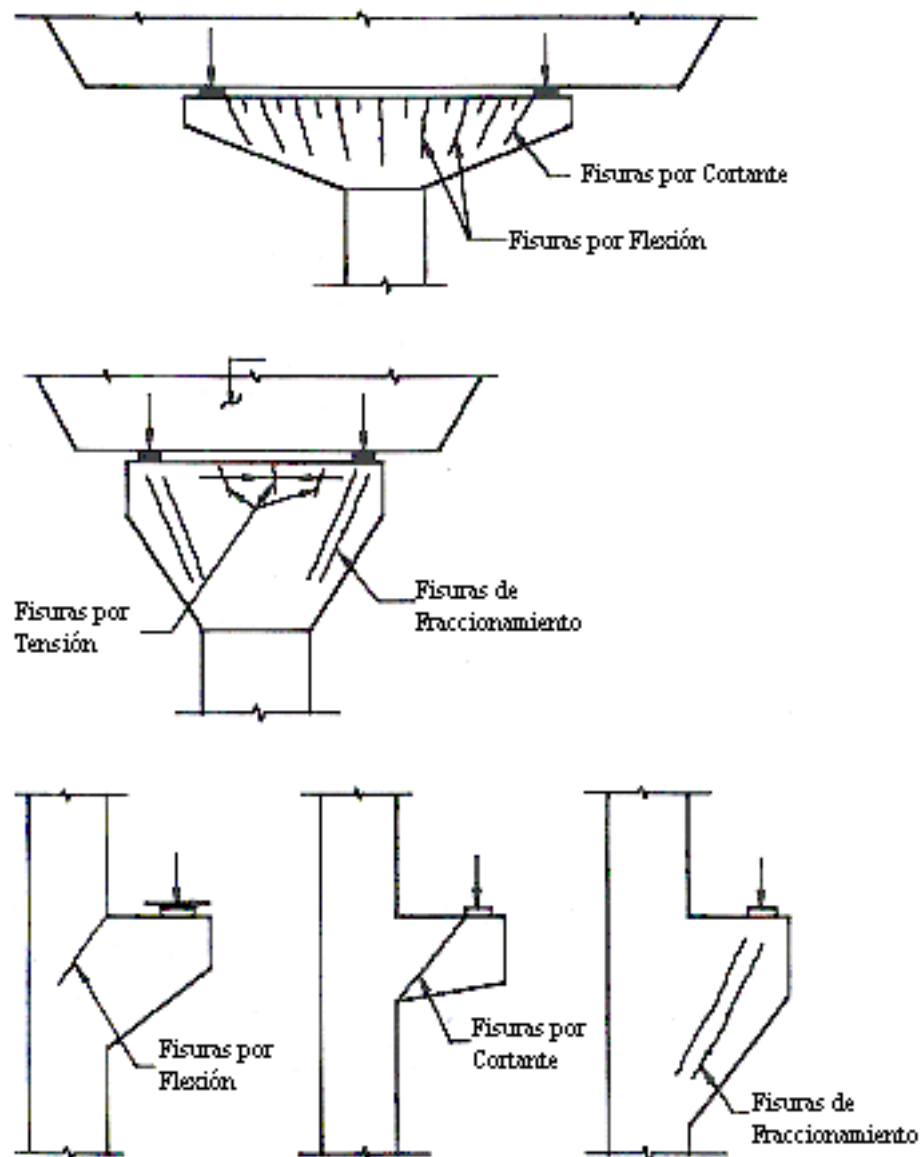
Diferentes Tipos de Fisuras en elementos de infraestructura.
